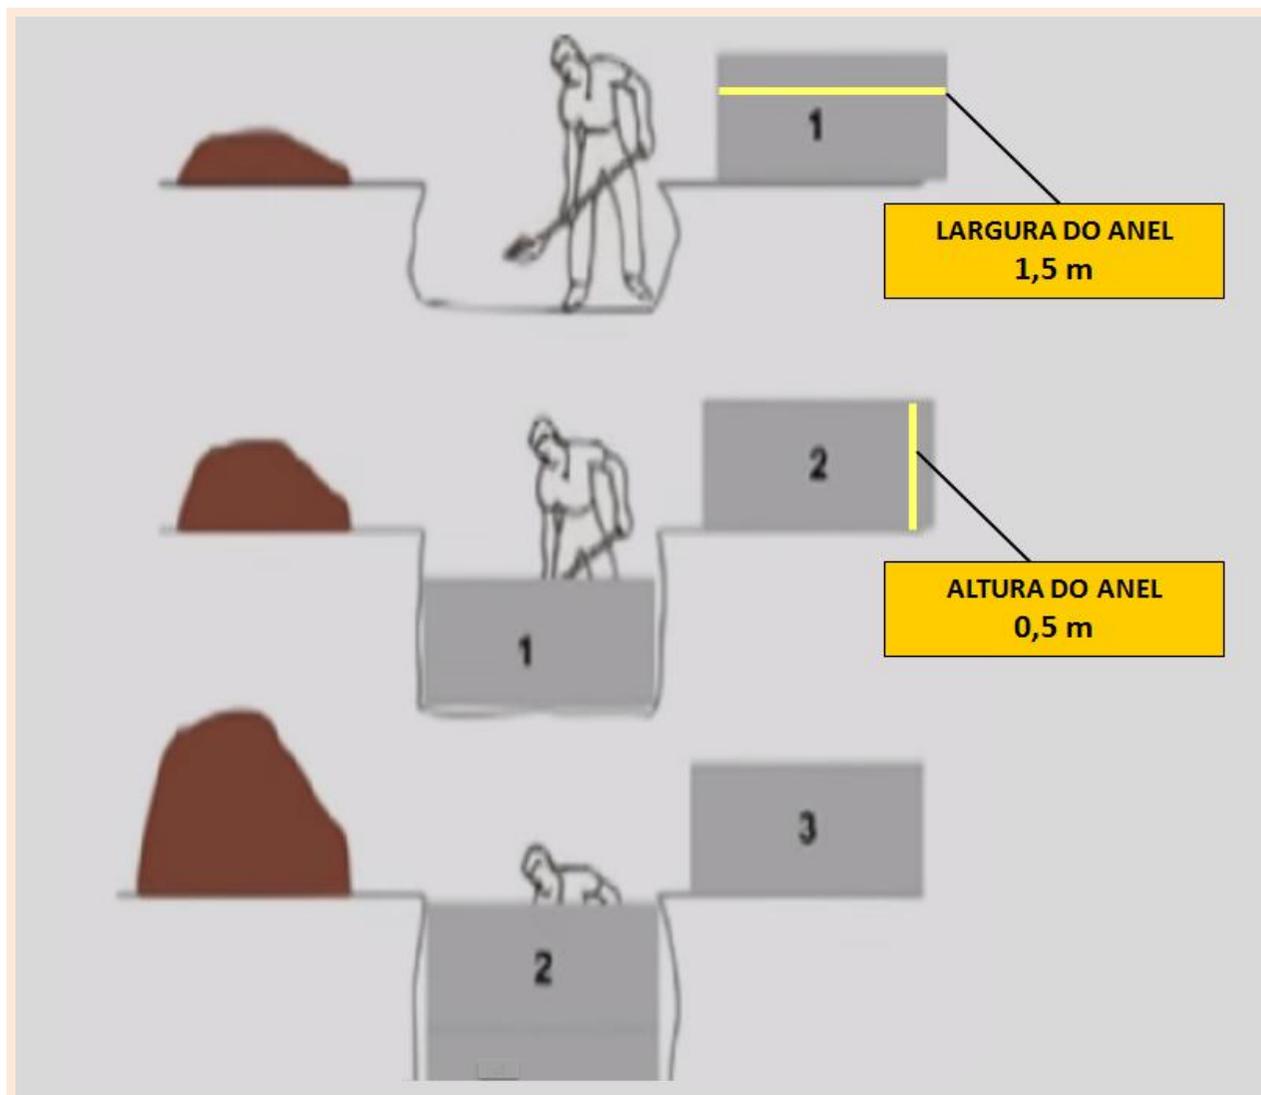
Demonstração da construção do poço amazonas com anéis (manilhas)
